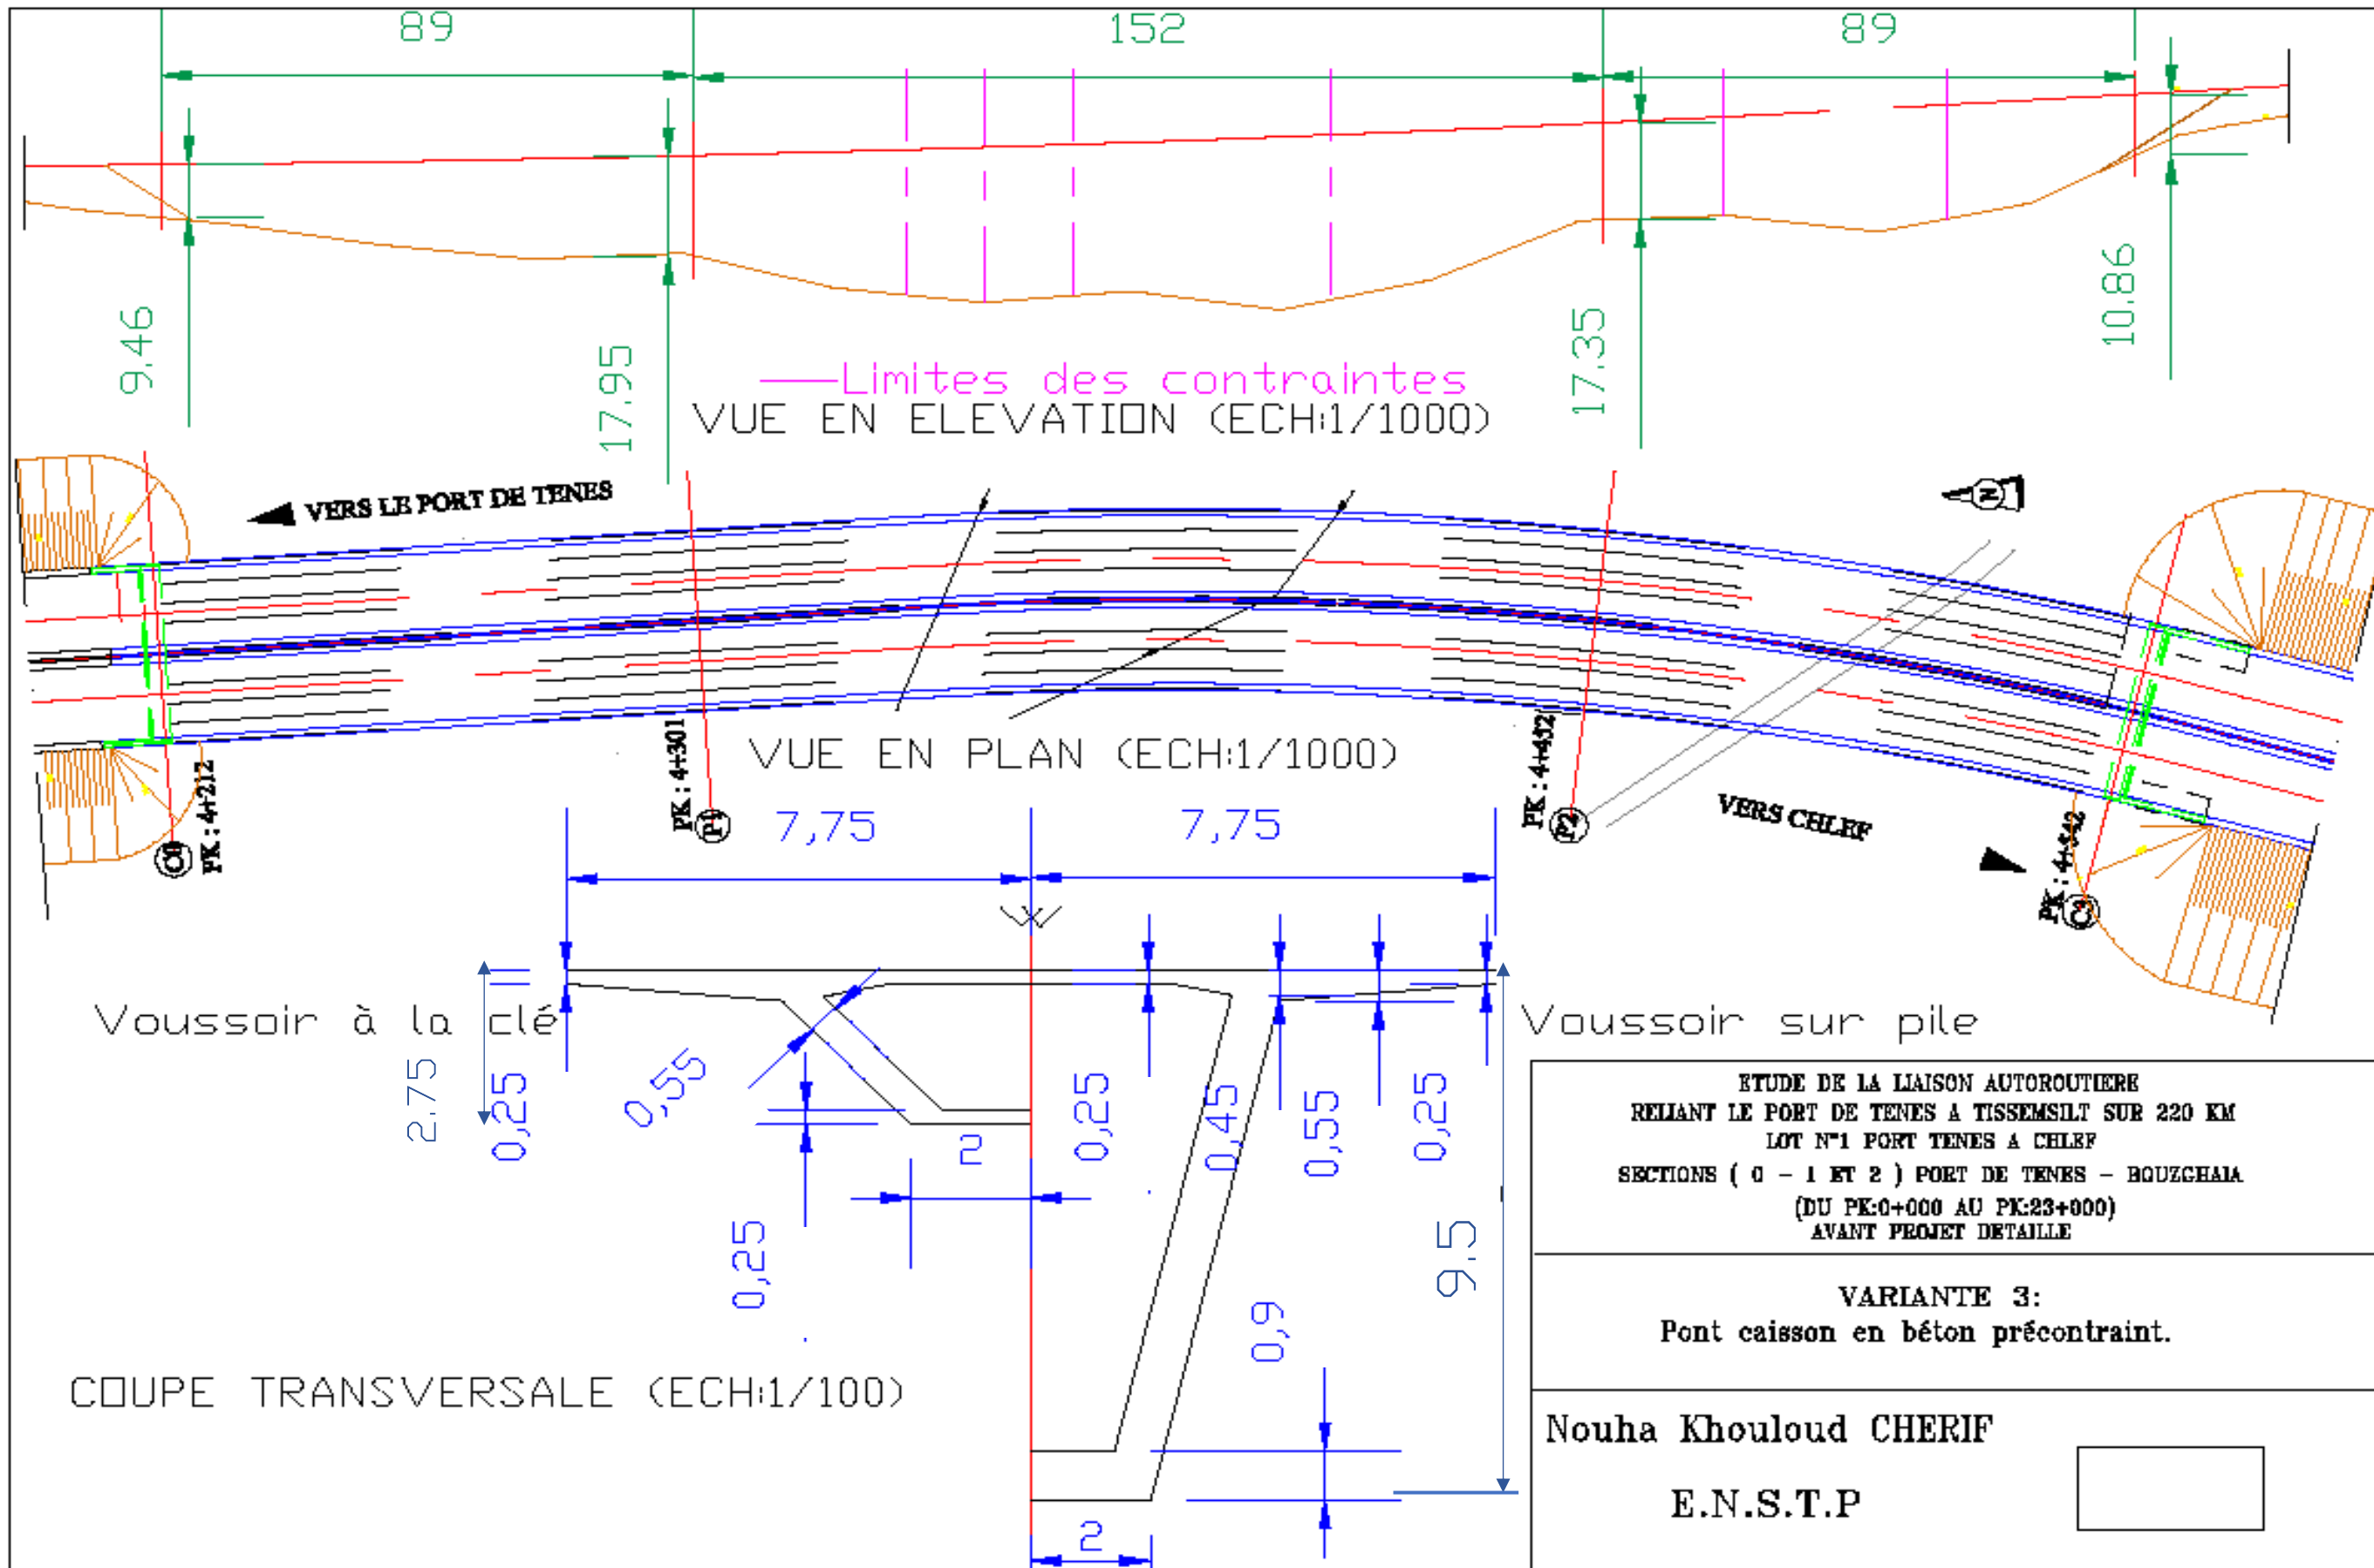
Coupes transversales, vue en plan et vue en élévation de la 3^e variante
